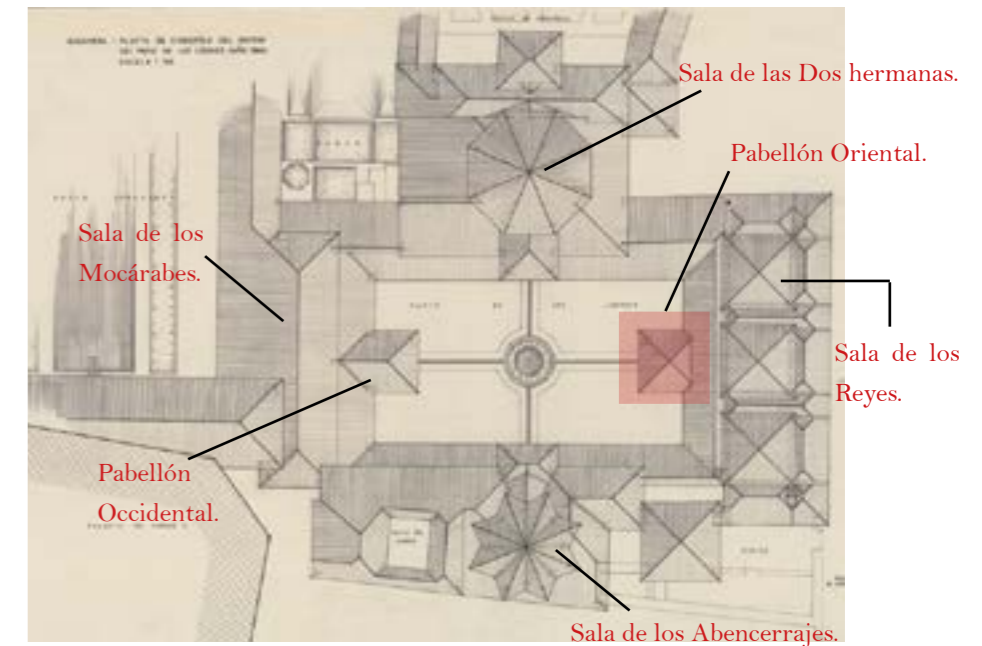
Planta cubierta Patio de los Leones, 1964.
